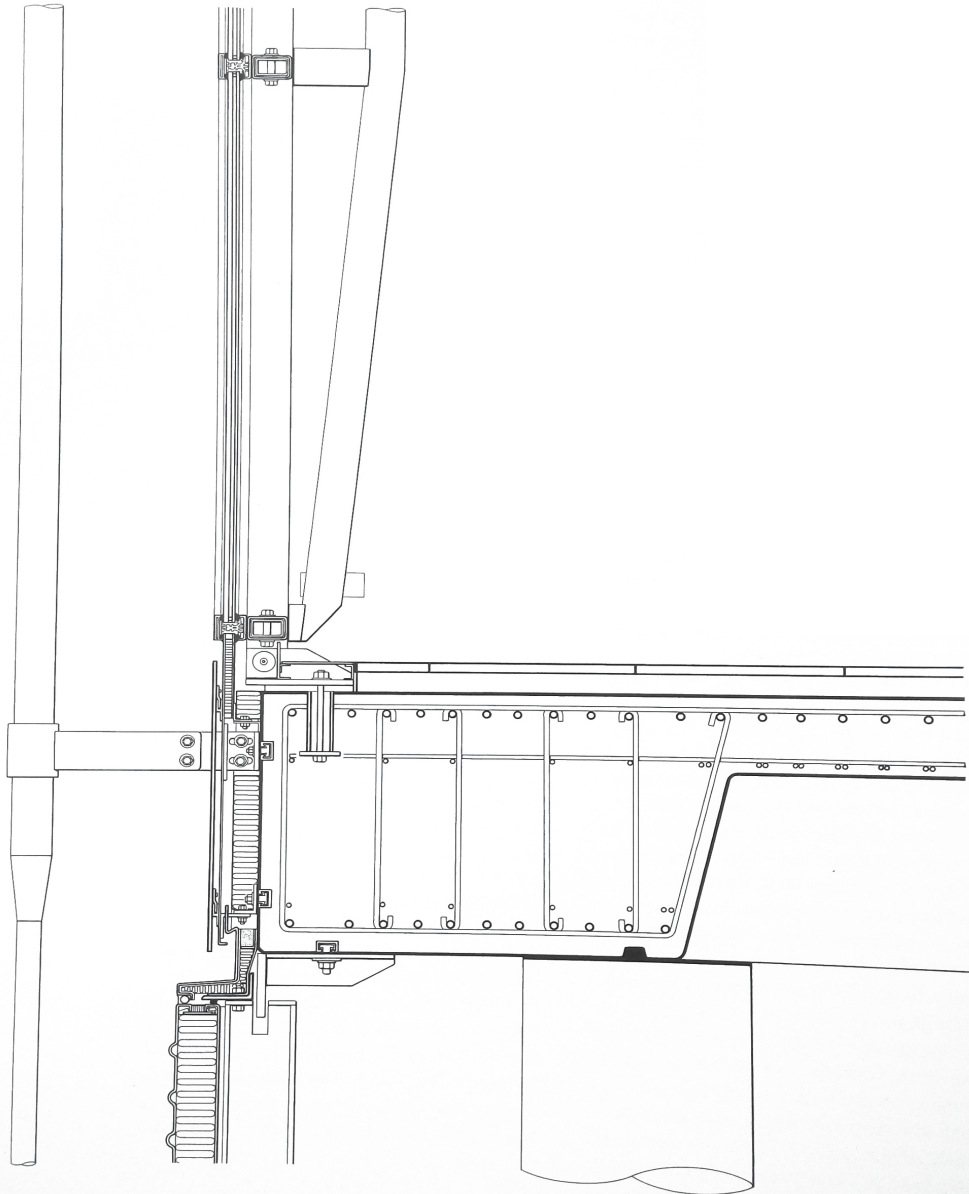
Detalle constructivo del encuentro del muro cortina con el forjado
